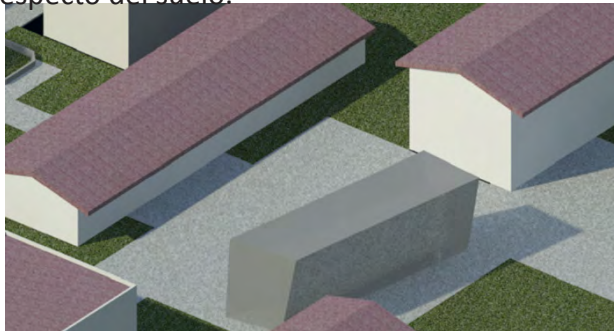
y 150. Modificaciones y perspectiva del primer elemento del segundo edificio.
